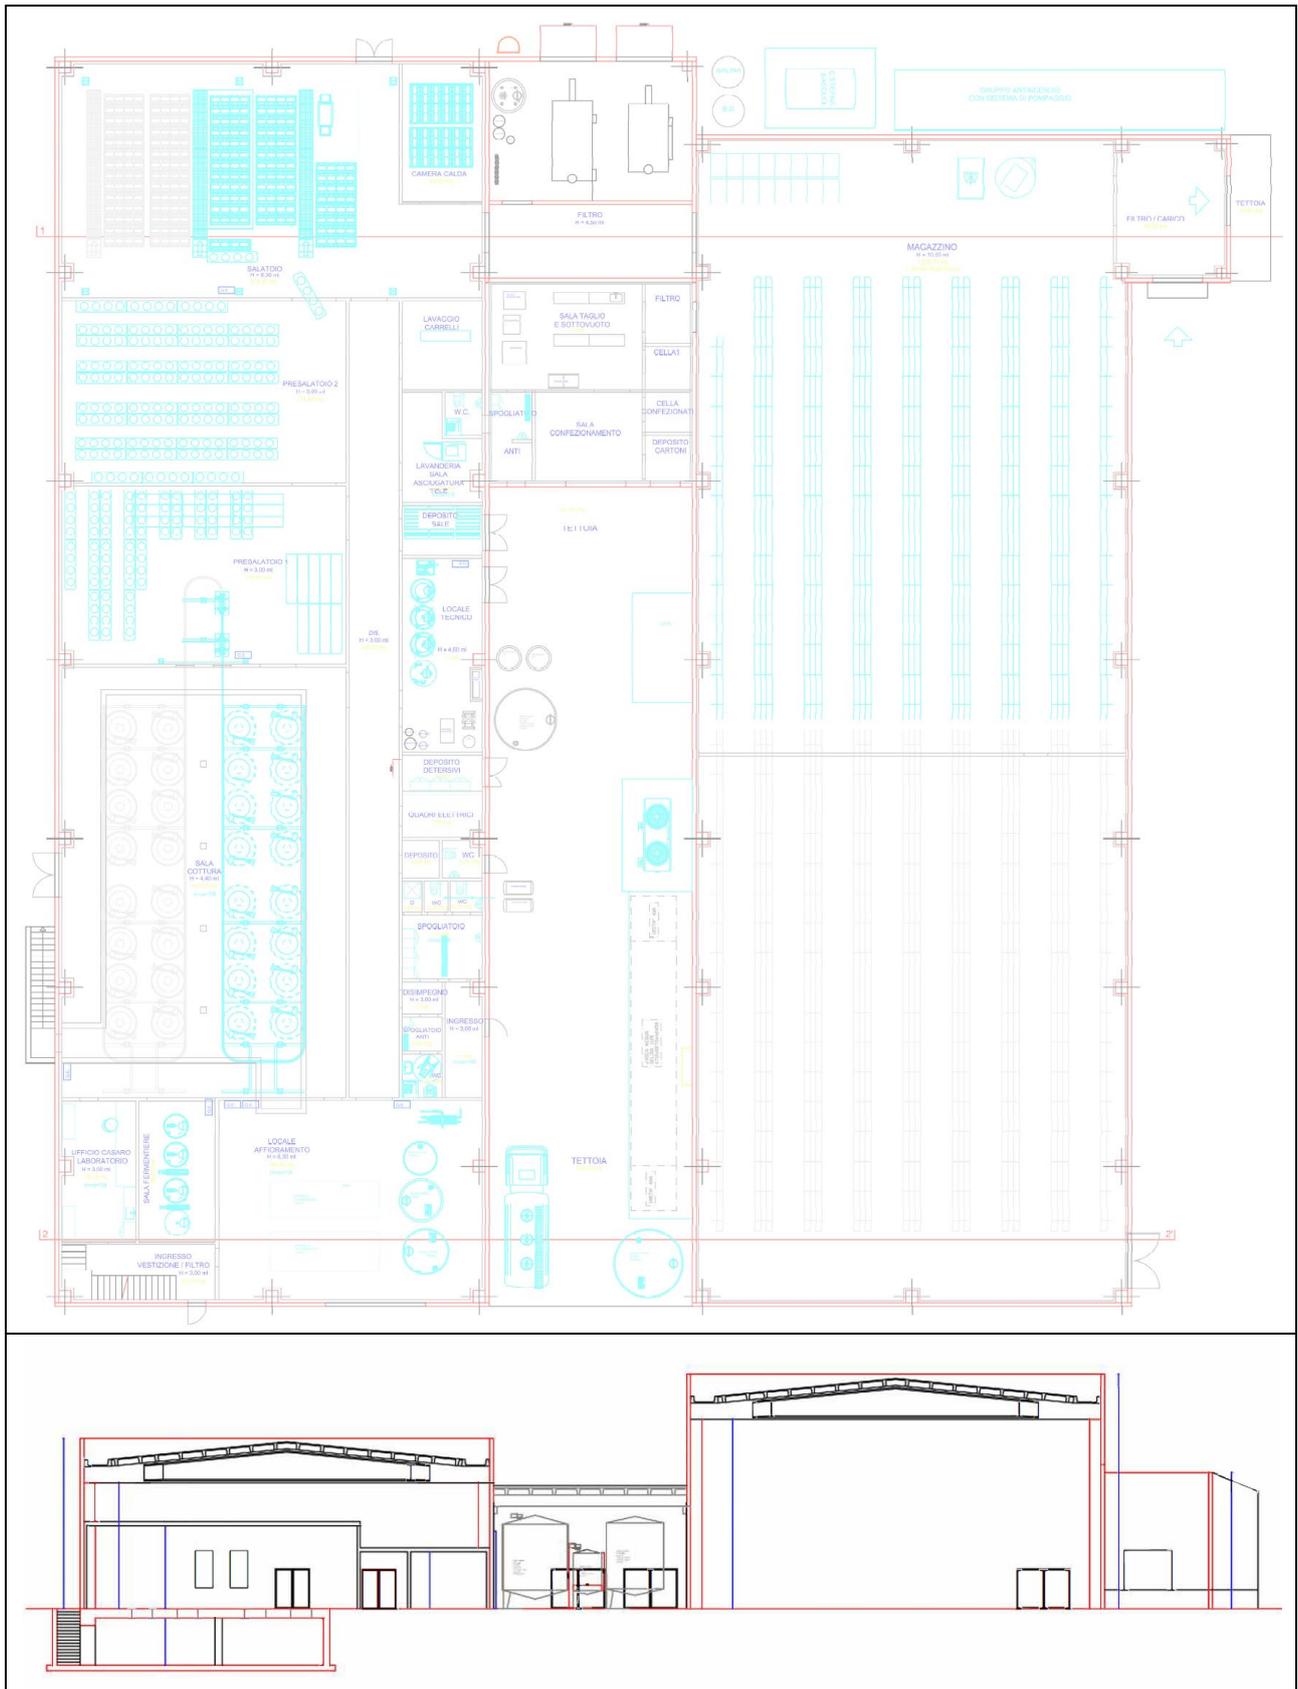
Pianta nuovo caseificio e vista prospettica da via Spinzola
